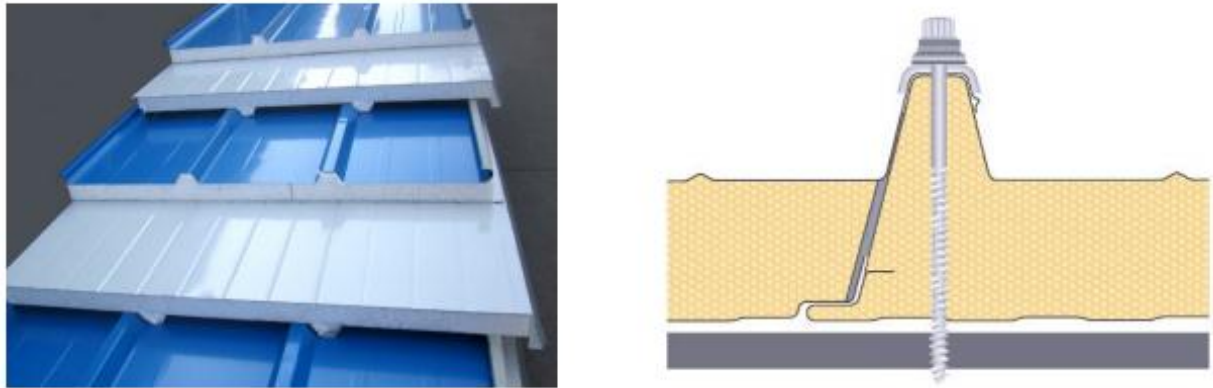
Panel Sandwich Cubierta
